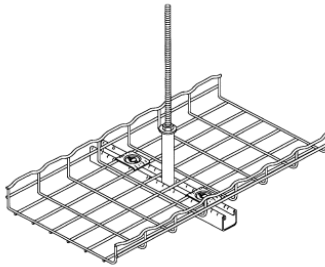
Askı çubu tutucu montaj şekilleri
